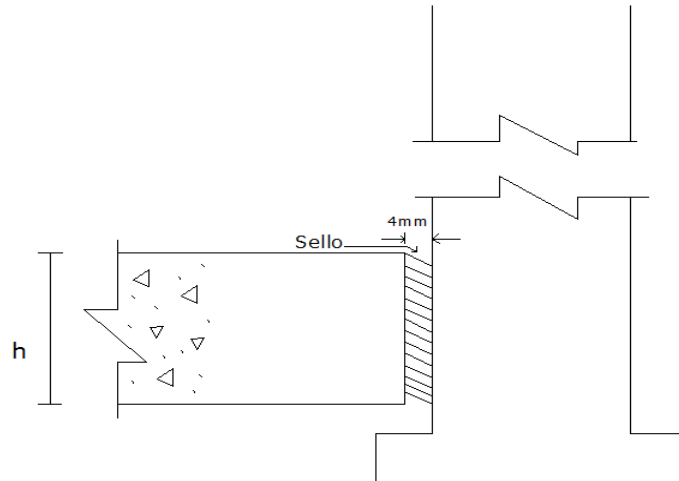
Junta de expansión para pavimentos rígidos.
